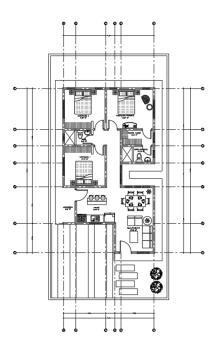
Planta arquitectónica, Vivienda Macuelizo
